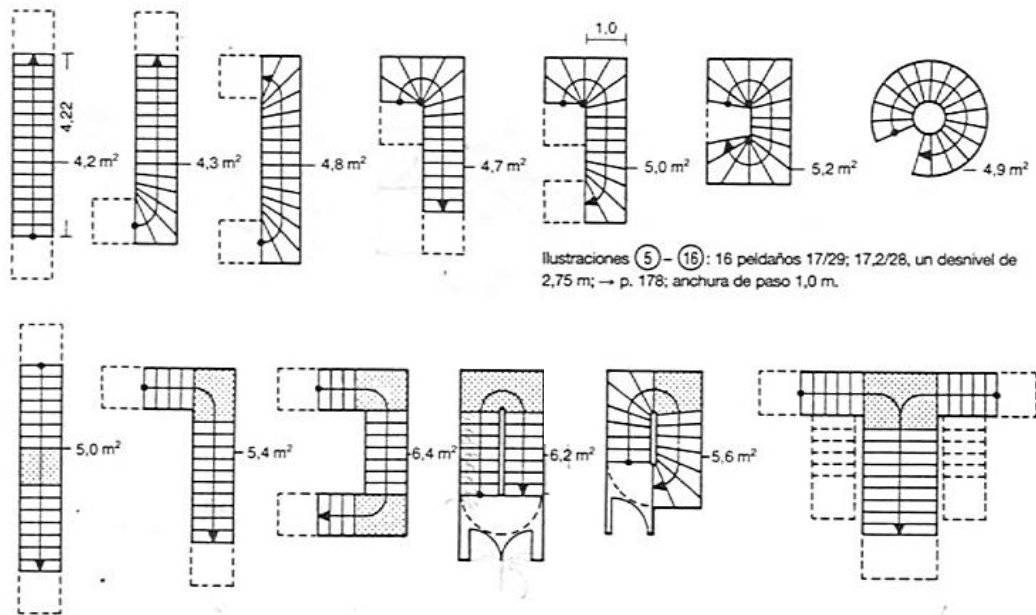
Tipos de Escaleras y Dimensiones para circulación.
